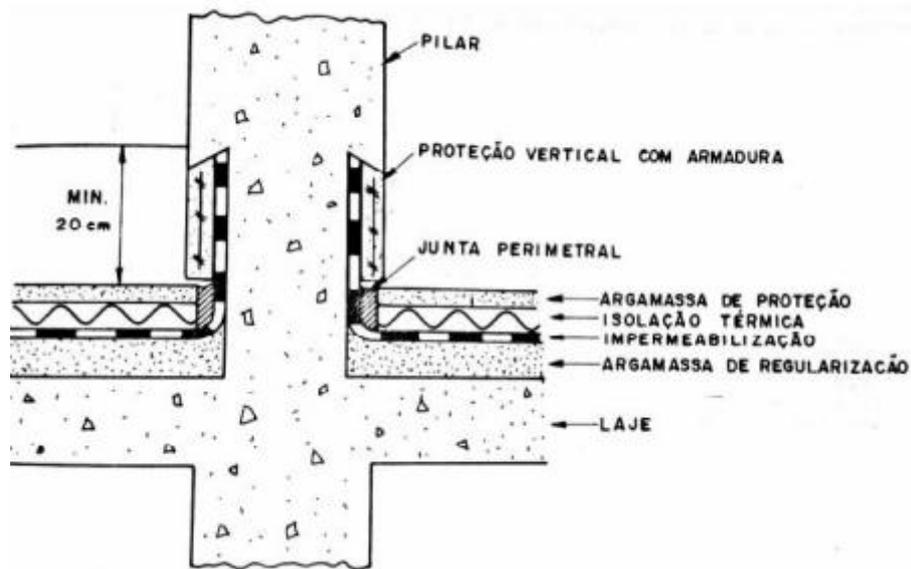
Impermeabilização rodapé com embutimento no plano vertical (PICCHI, 1986).
